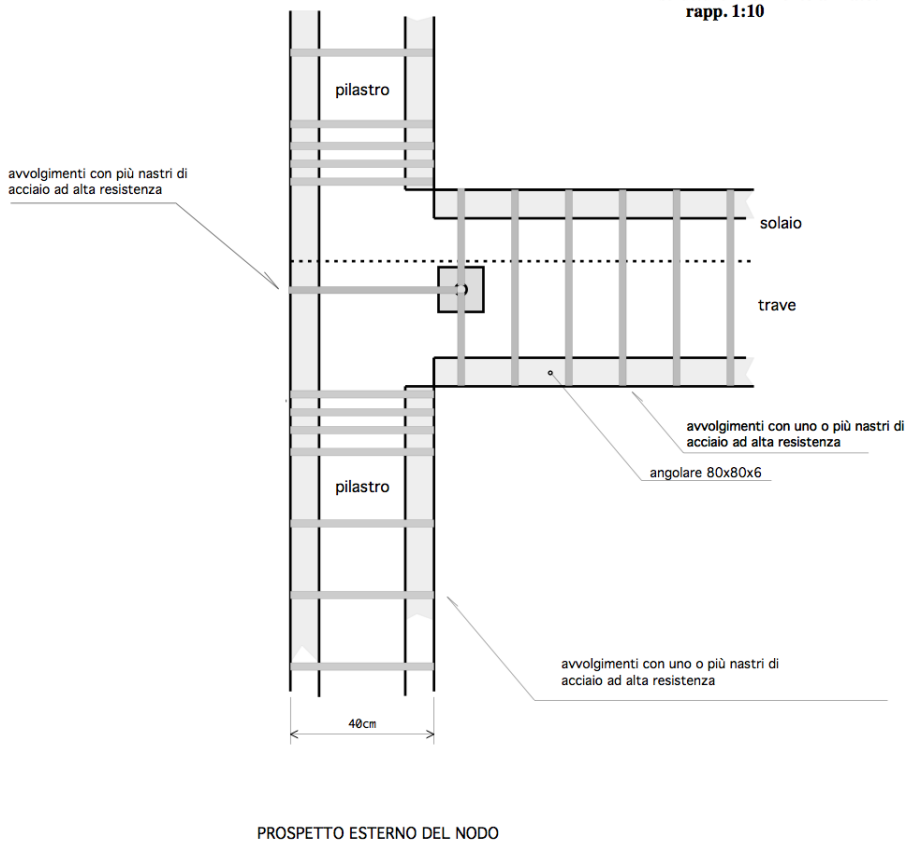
Applicazione del sistema su un nodo trave pilastro di angolo
